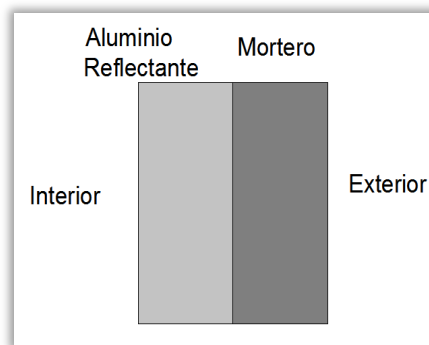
Configuración muros exteriores y exteriores aberturas anidolicas cenital [18]
